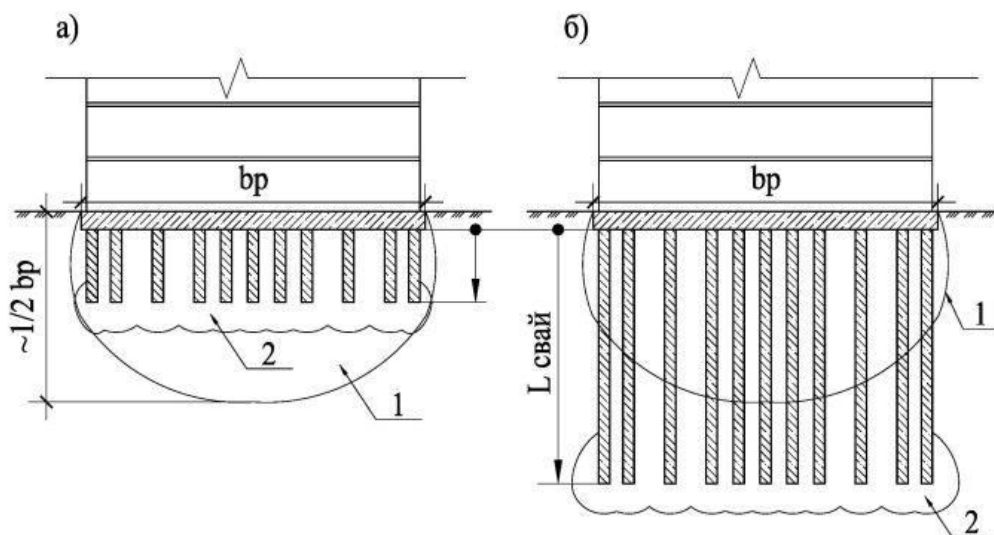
Взаємодія фундаментних конструкцій з ґрунтовим масивом:
